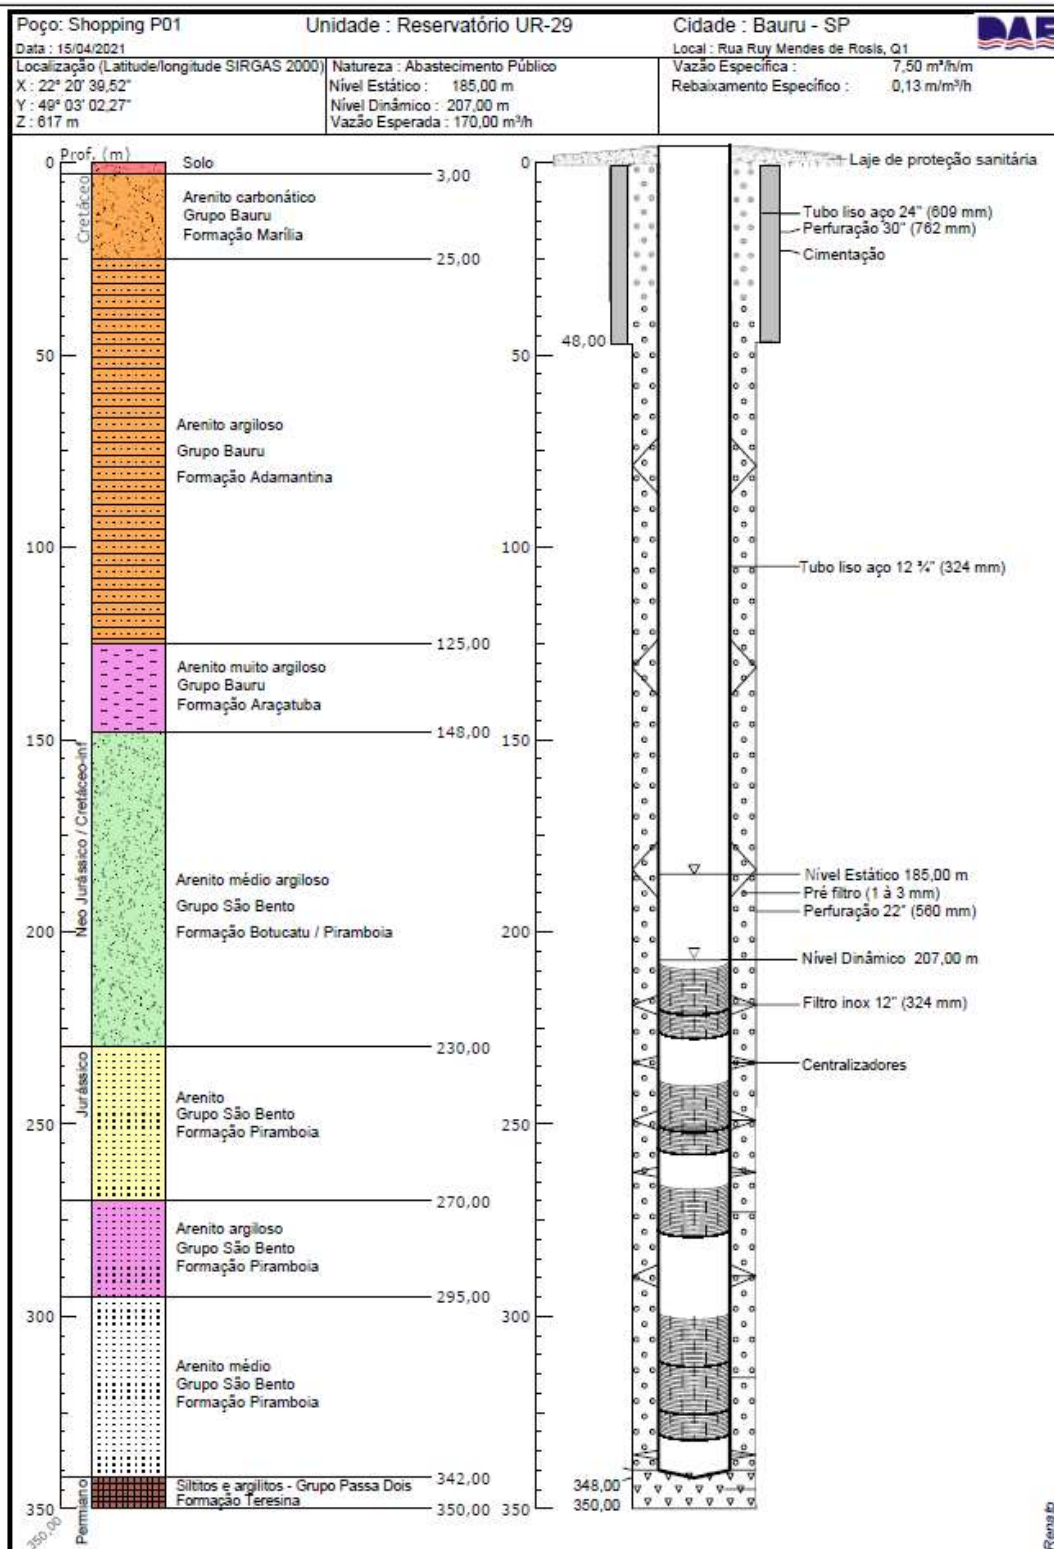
Projeto de construção e geologia prevista para o poço Shopping.
